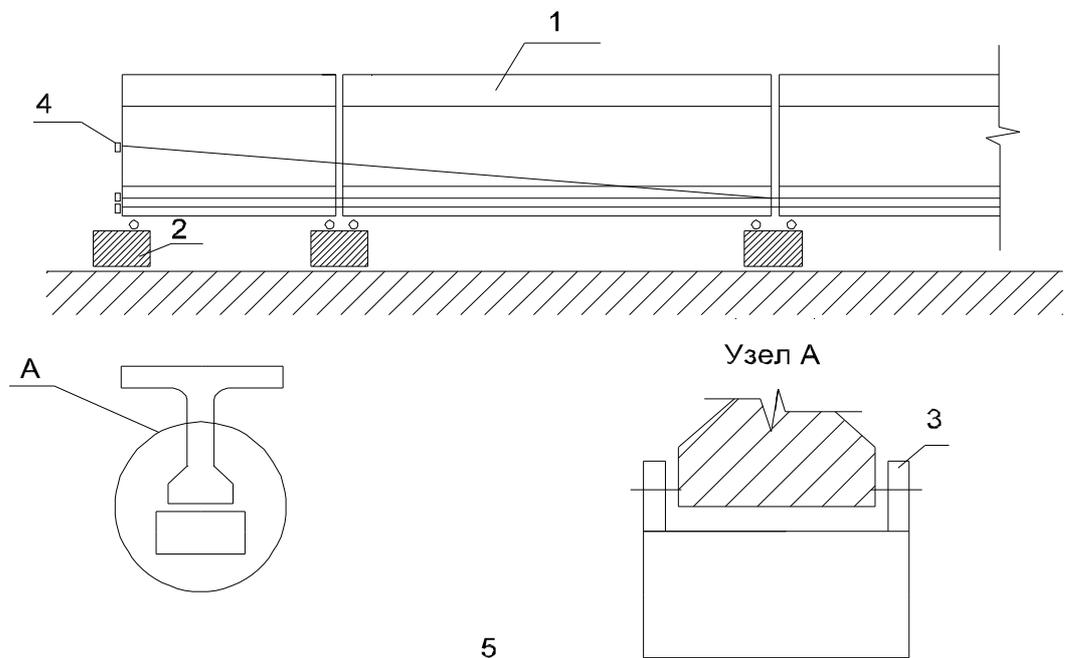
Схема укрупнительной сборки балки из блоков: 1-блок балки; 2-опора стапеля для укрупнительной сборки балки; 3-струбцины для фиксации сборных блоков в проектном положении; 4-внешний анкер арматуры;
